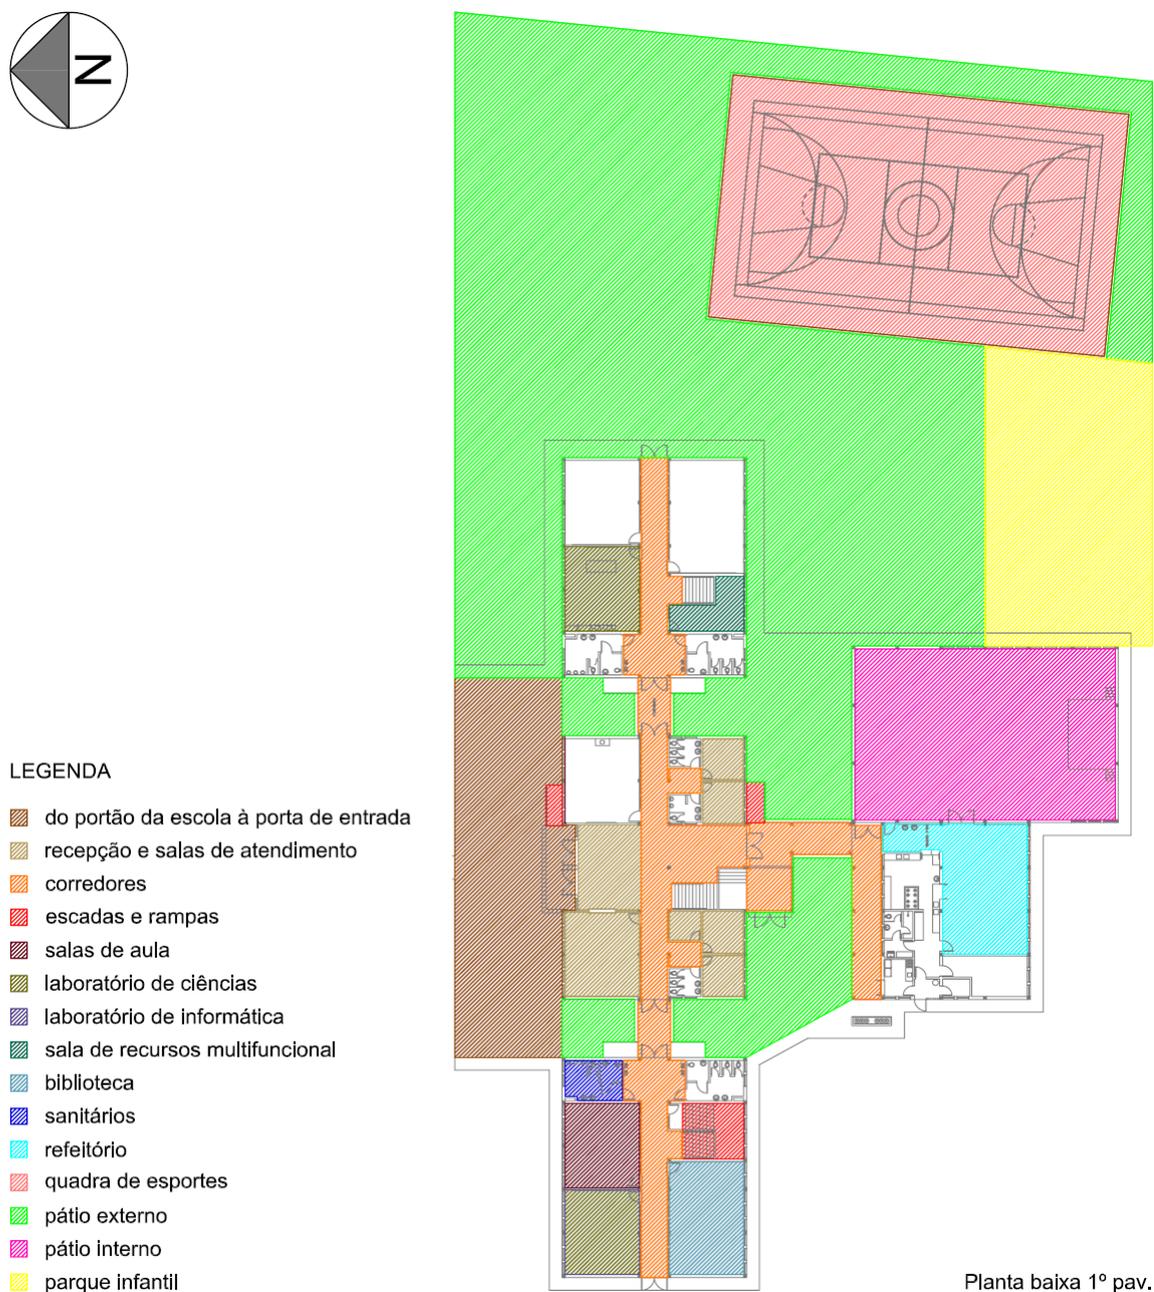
Planta baixa E.M.E.F.Rio de Janeiro
